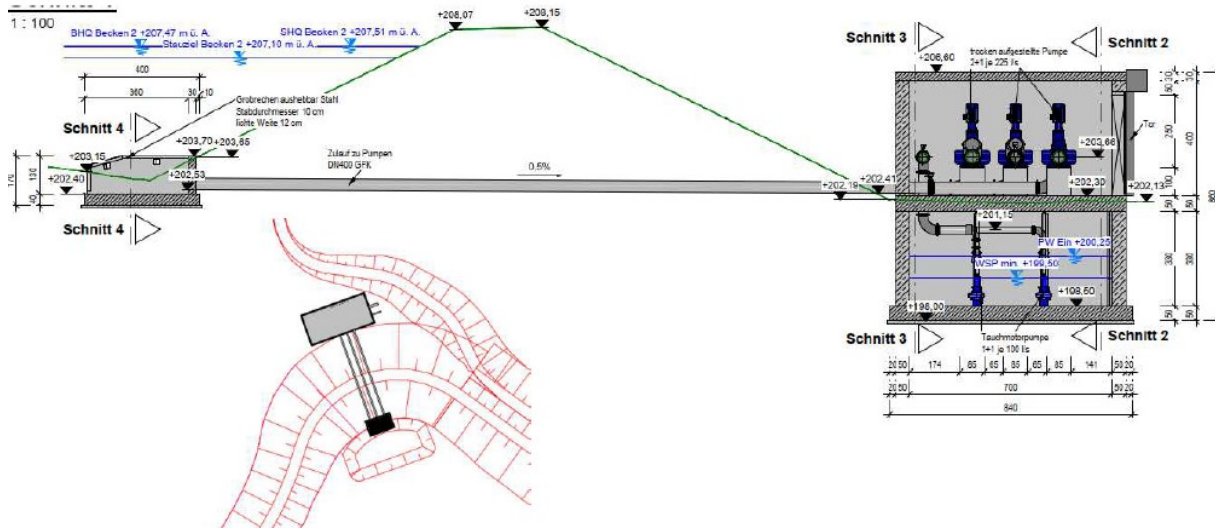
Lage und Schnitt durch des Pumpwerk mit Durchlassleitung ([13], Kap.7.5.4, Abb.46)
